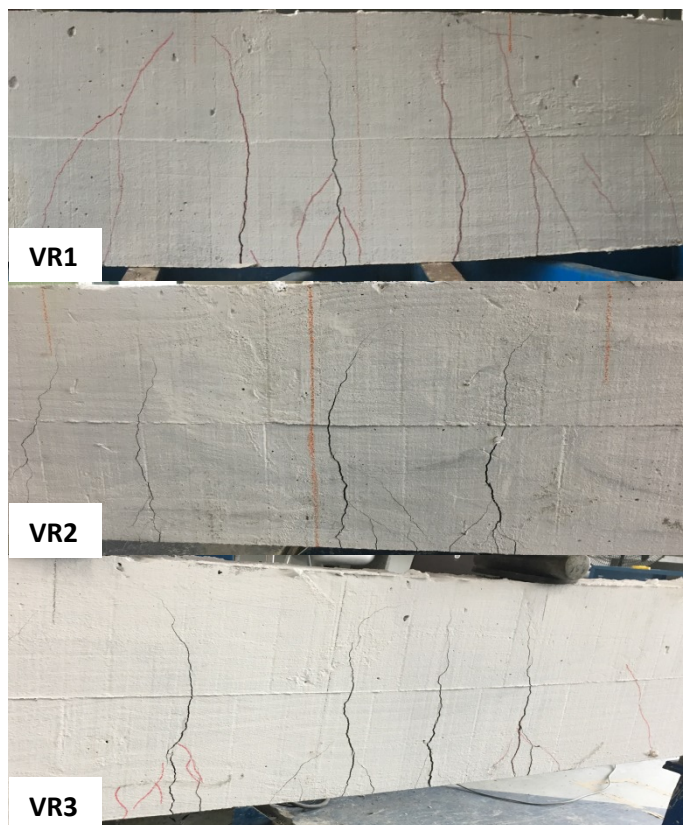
Mapeamento das fissuras nas vigas do grupo VR.
